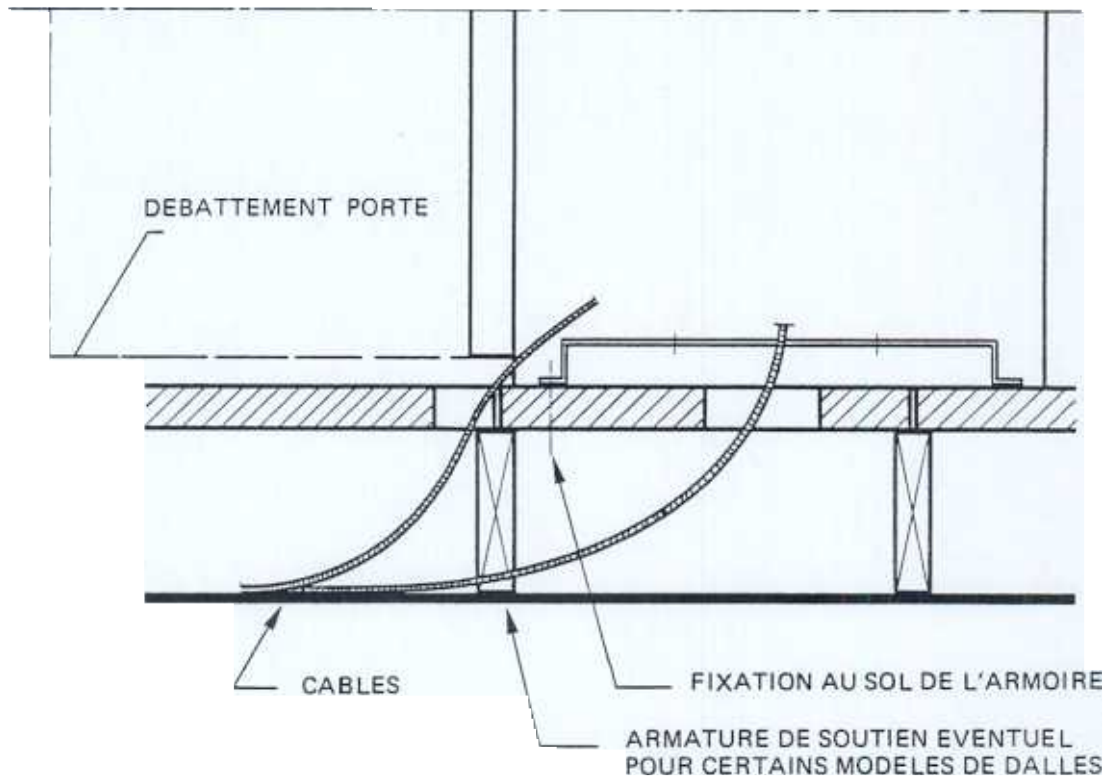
ARMOIRE SUR PLANCHER TECHNIQUE
